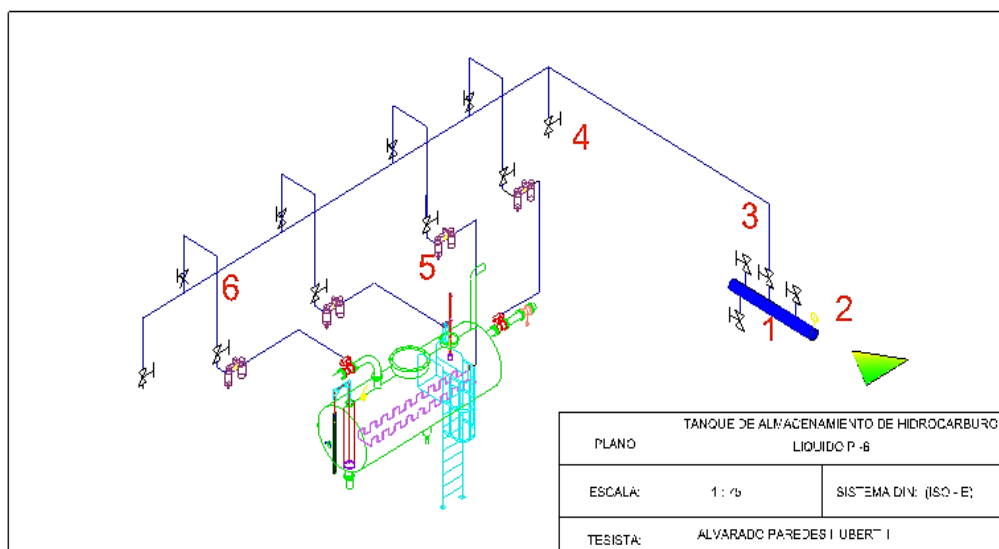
Dimensiones de tanque de almacenamiento de hidrocarburo líquido PI-6
